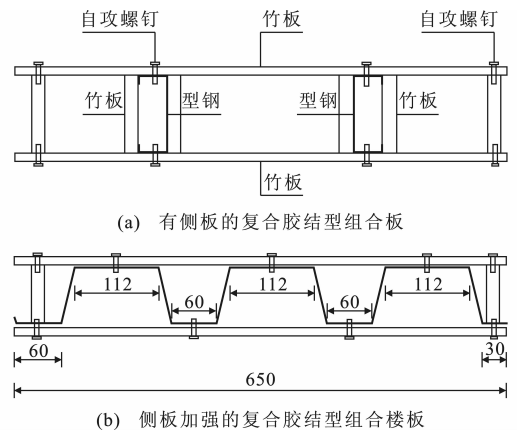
薄壁型钢-竹胶板组合楼板(单位:mm)
